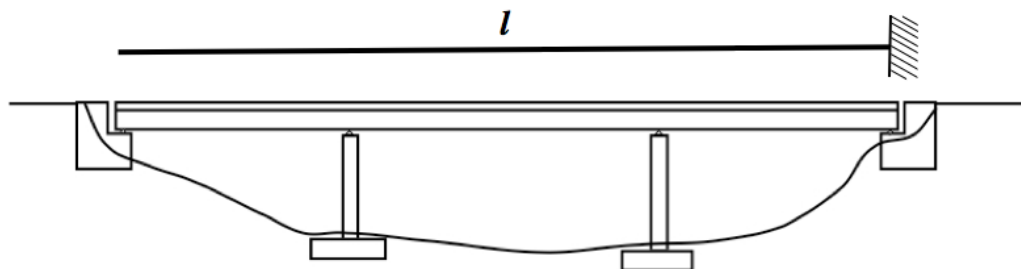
Modell mit flexiblem Überbau (oben) für die Ersatzkraftanalyse einer längeren geraden Balkenbrücke mit fester Längslagerung an einem starren Widerlager (unten).
